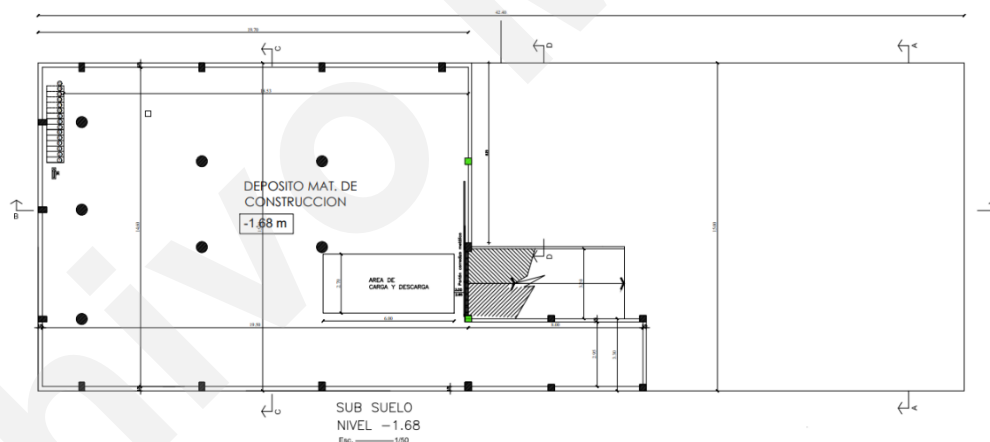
Plano constructivo del área de depósito de Materiales en sub-suelo. Fuente: Plano Municipal elaborado por Ing. Jorge Cristaldo PAT 19.399
